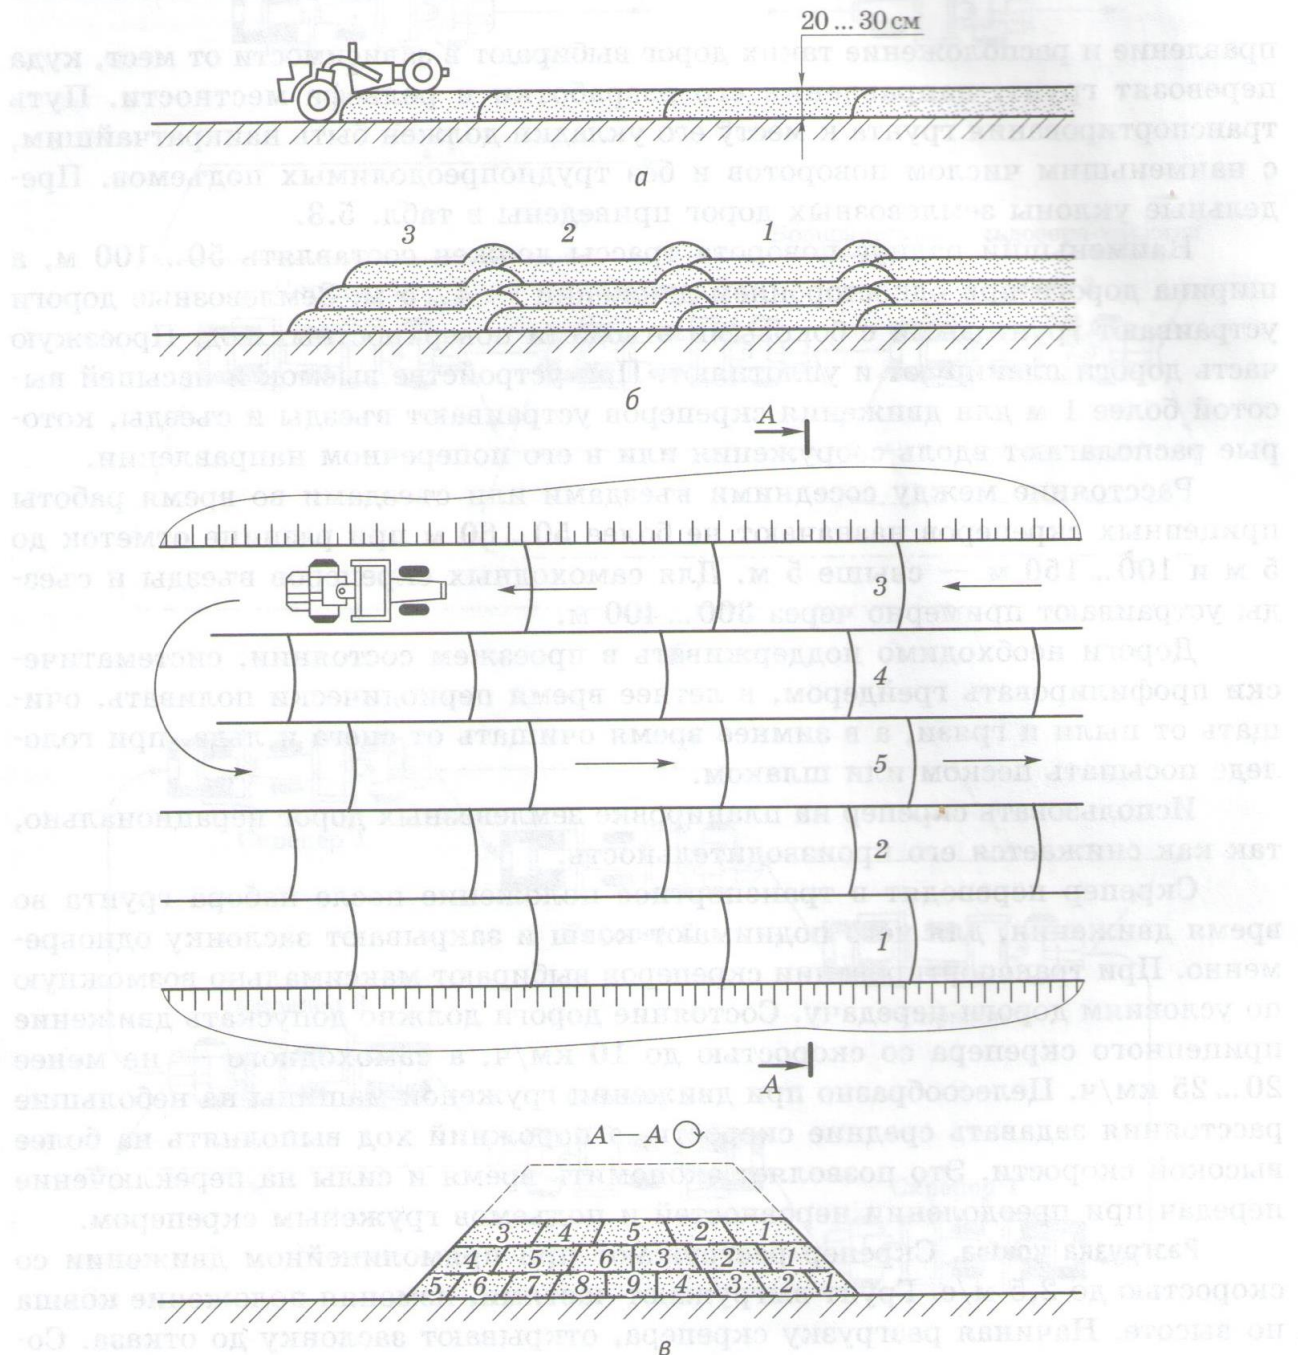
Схема отсыпки грунта при разгрузке:
